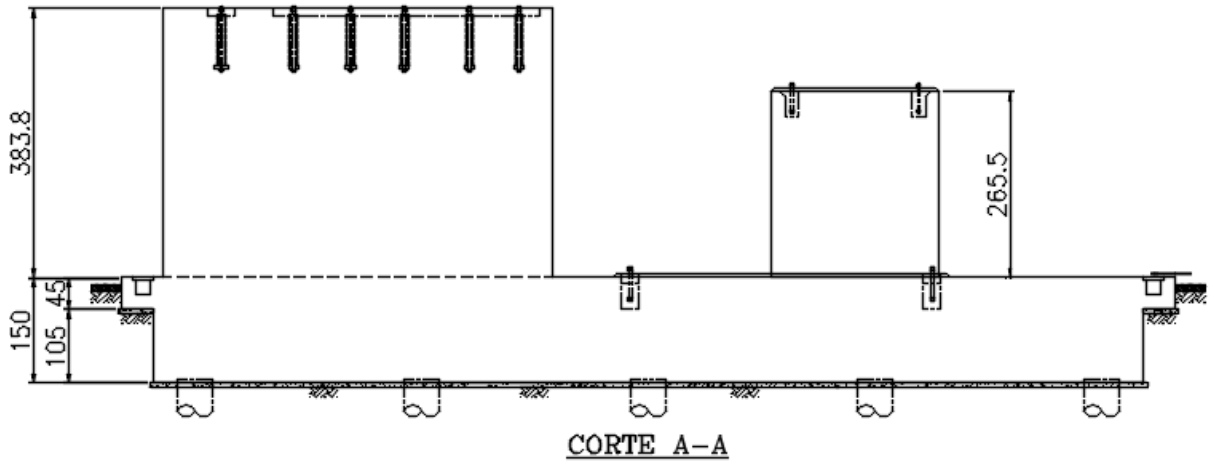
Modelo estrutural: elevação da fundação (Corte A-A)
